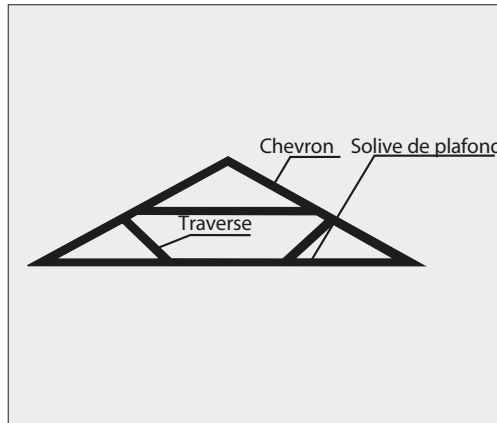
Charpente conventionnelle de toit dont les traverses sont fixées aux solives de plafond.
